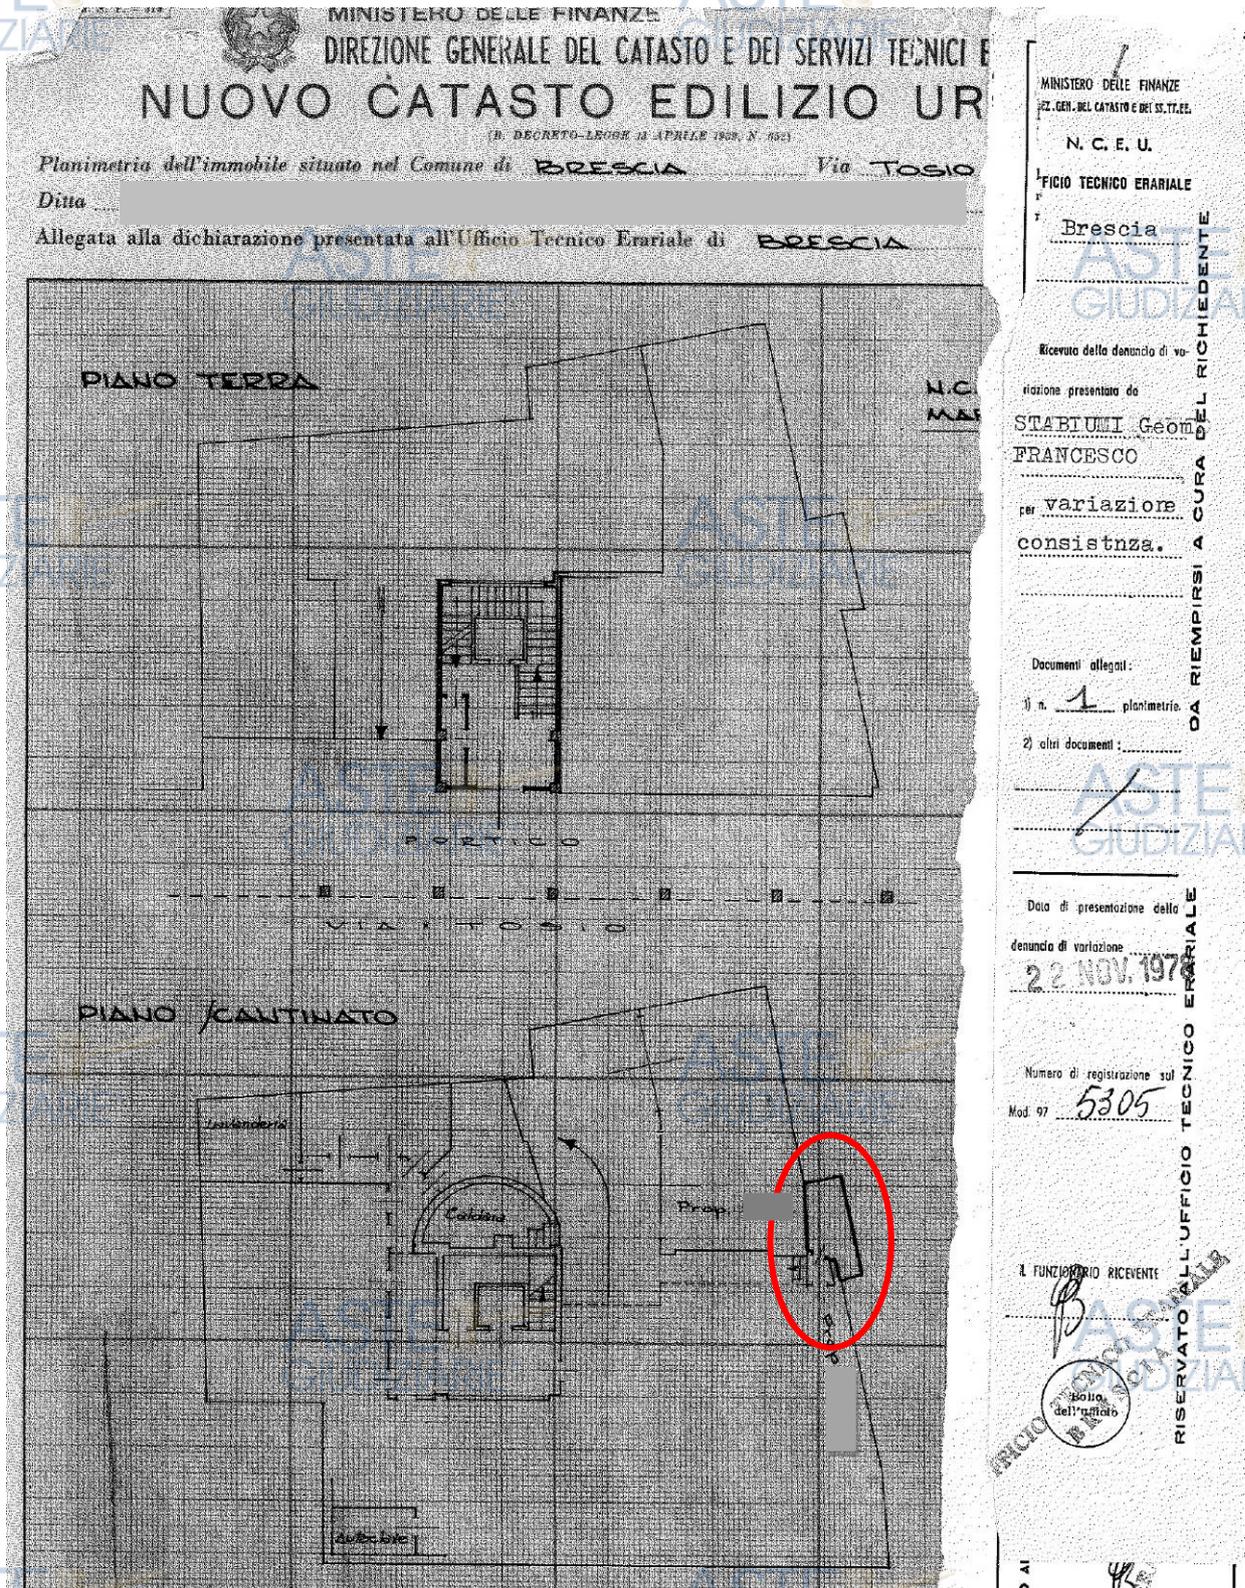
Estratto planimetria catastale Fg. 35/5 scheda 5305 del 22.11.1978 allegata ad Atto di Permuta Rep. 33537 Not. Barca
